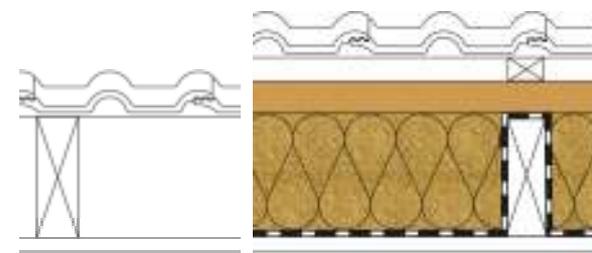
Holzfaserdämmung des Daches (vorher-nachher)
